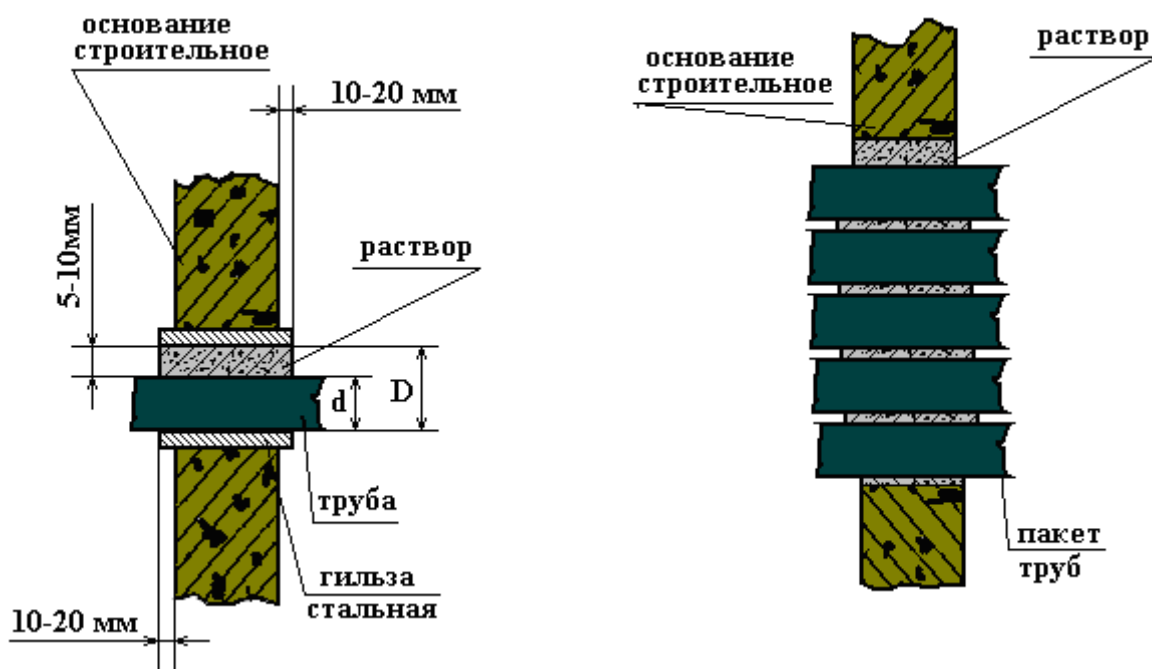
Переход стальной трубы через вертикальное строительное основание
